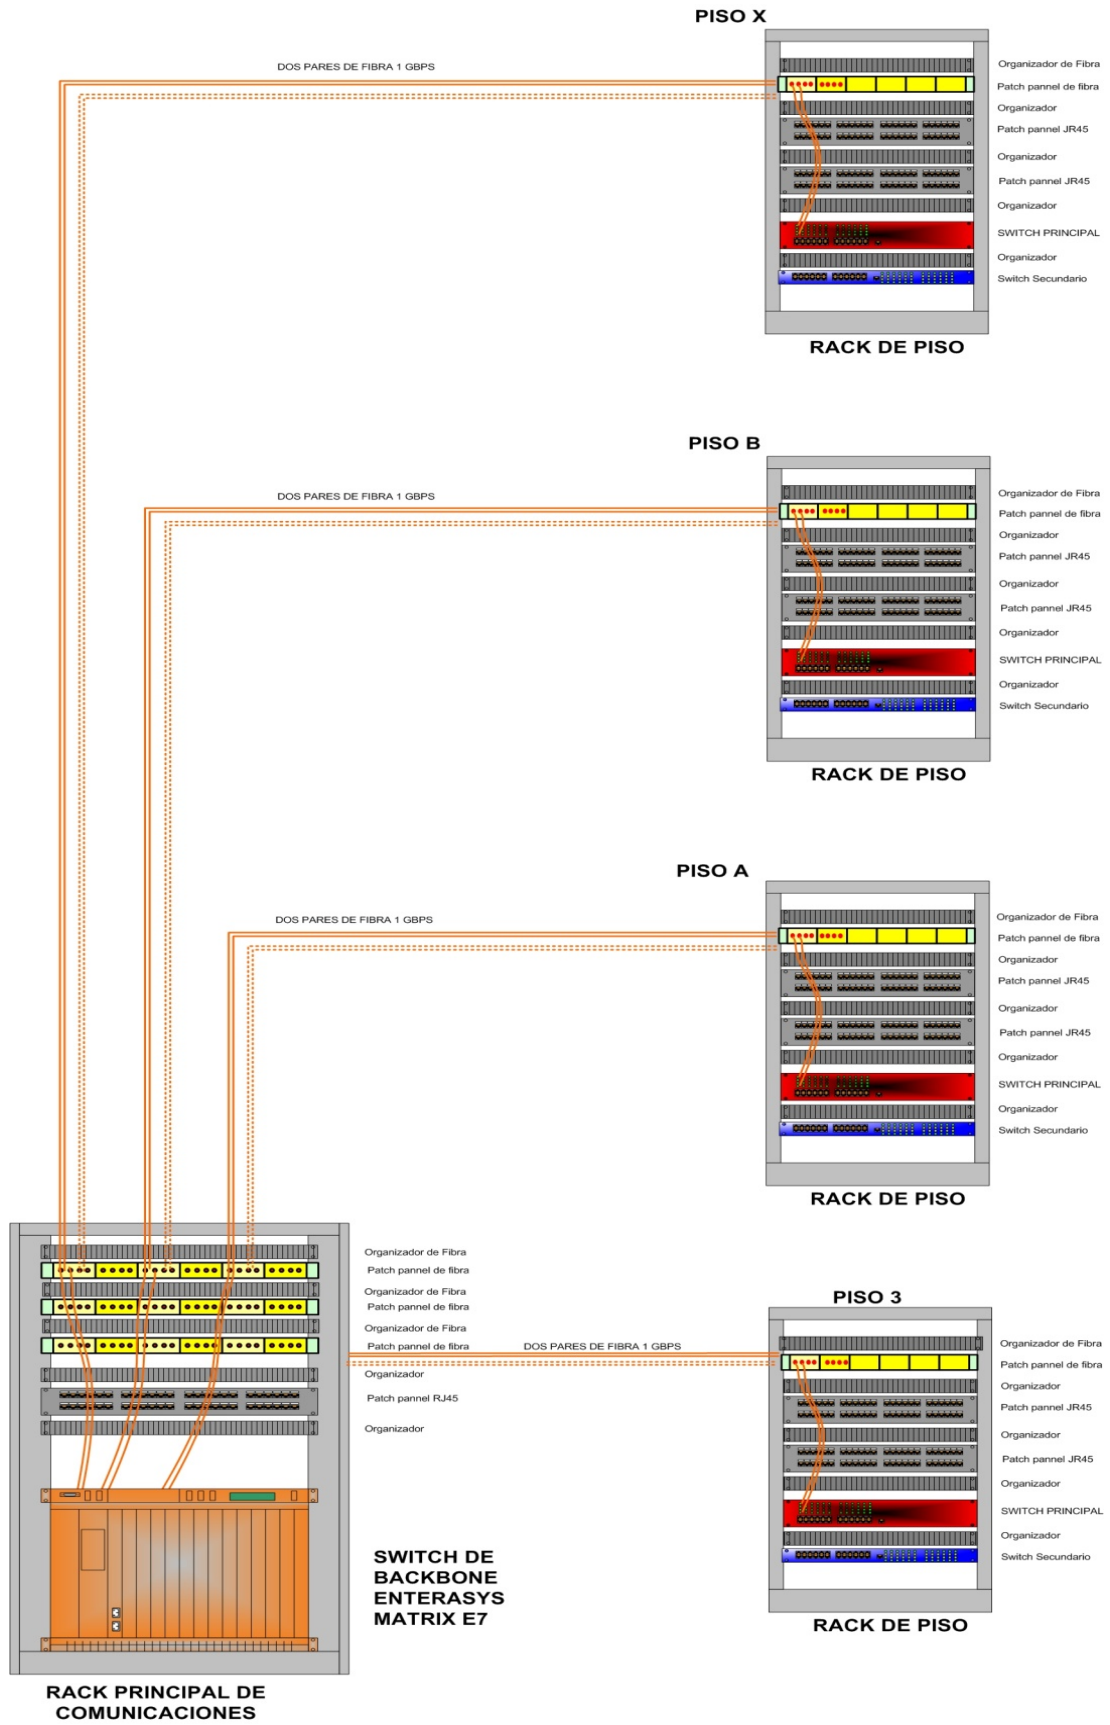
Distribución de cableado estructurado vertical de fibra óptica en Quito
